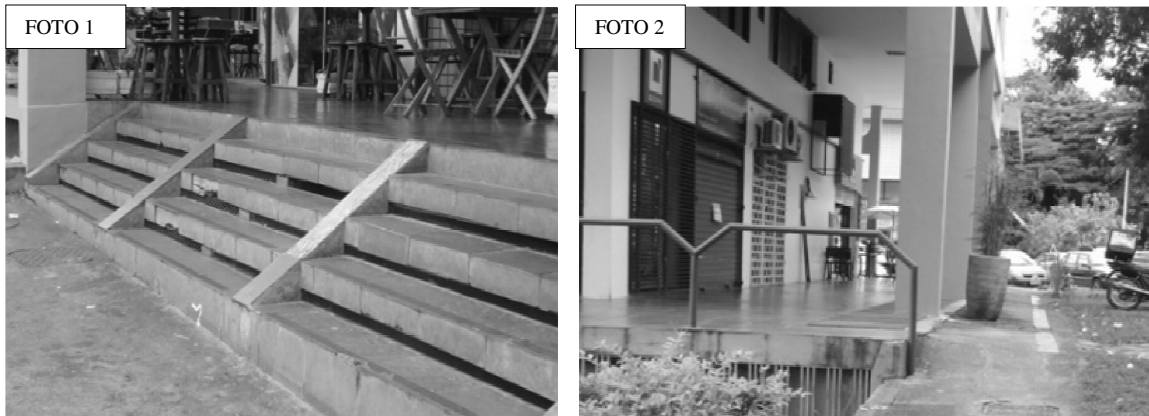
Foto 1, Escada 407NEE1; Foto 2, acesso ao Bloco E
